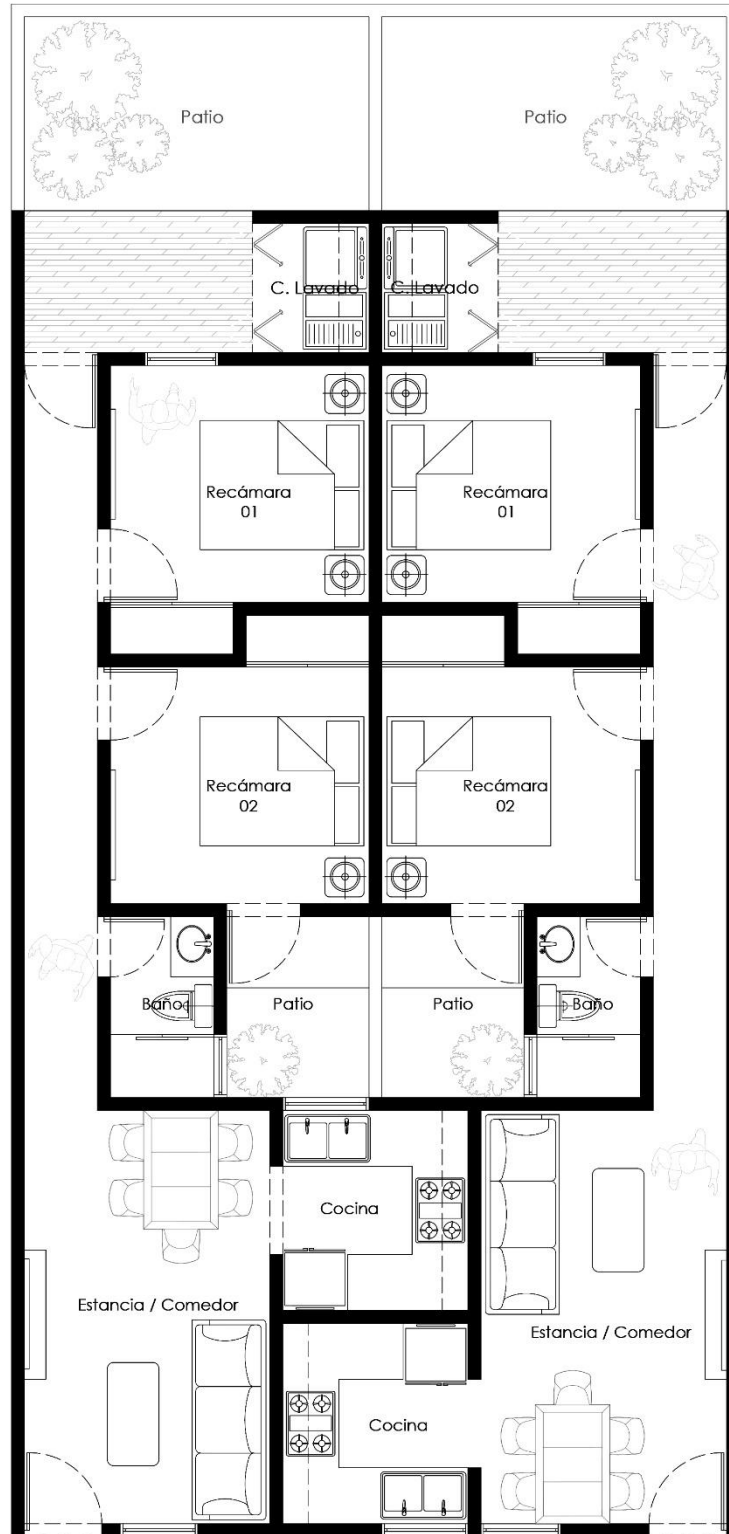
Planta arquitectónica tipo de las viviendas analizadas
